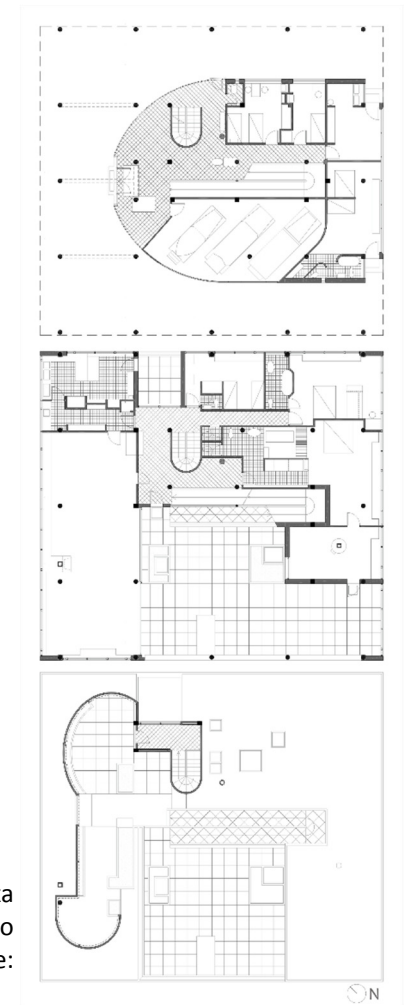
Vila Savoye, planta baixa do térreo, primeiro e segundo pavimento, respectivamente. Fonte: Autora, 2016.
